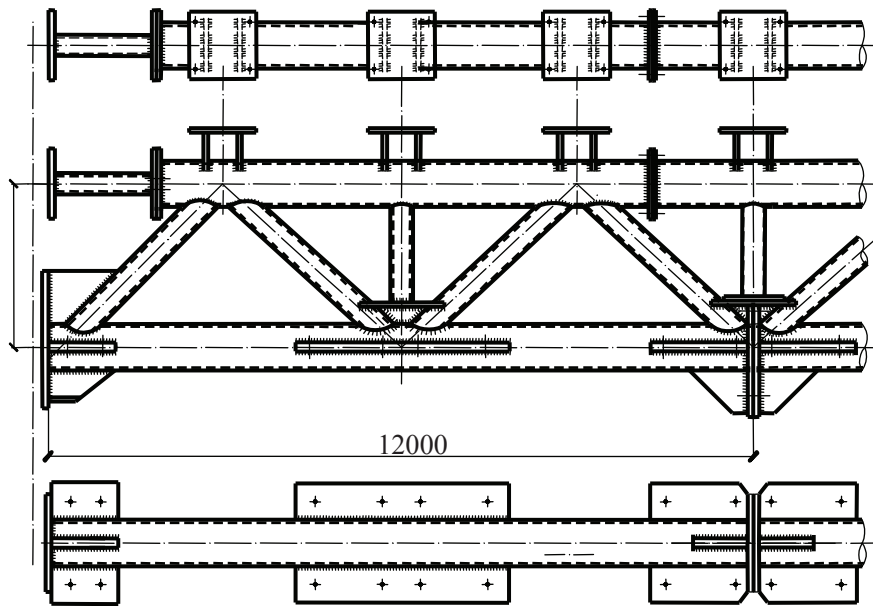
Кроковья труботетонна ферма прольотом 24 м
